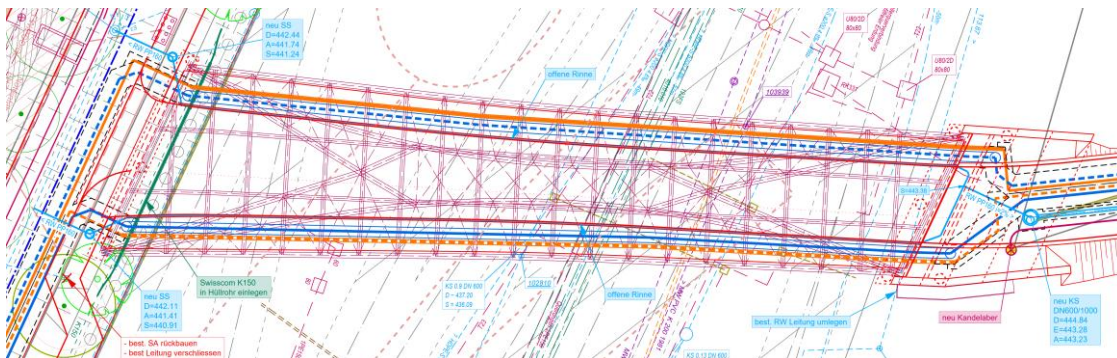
Situation Werkleitungen im Brückenbereich gem. Plan Nr. 12
